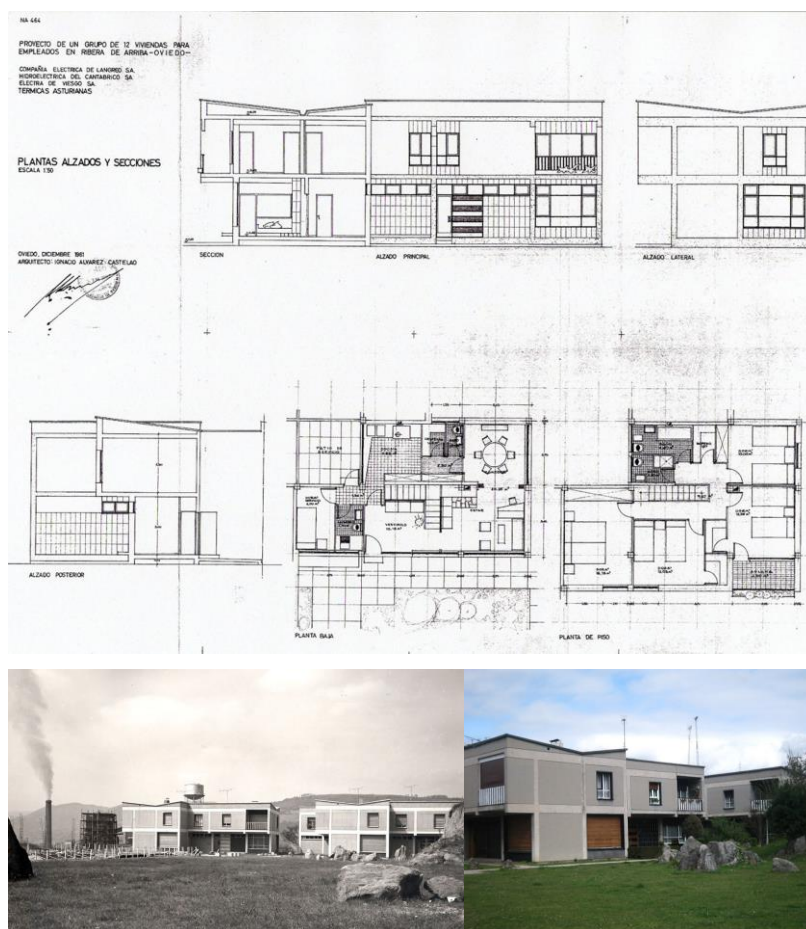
(superior): Conjunto de viviendas de Ribera de Arriba. Proyecto de I. Álvarez Castelao. Plantas, alzados y secciones. 1961. Figura 9 (inferior izquierda): Poblado de Ribera de Arriba, con las instalaciones industriales al fondo. Hacia 1963.
